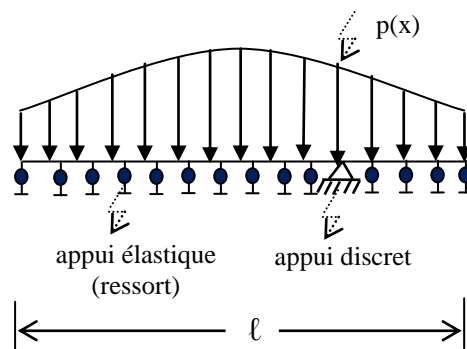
poutre sur appuis discret et sur appuis infiniment rapprochés
